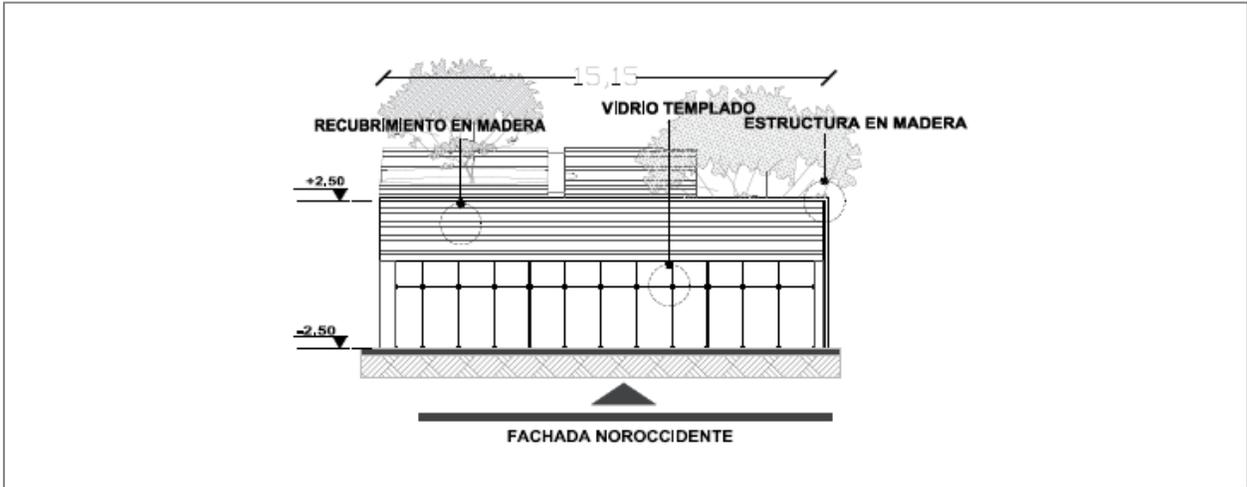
Fachada Noroccidente Edificio 4 (Rubiano, 2020)
